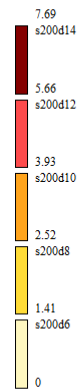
Площадь продольного армирования по оси X у нижней грани
